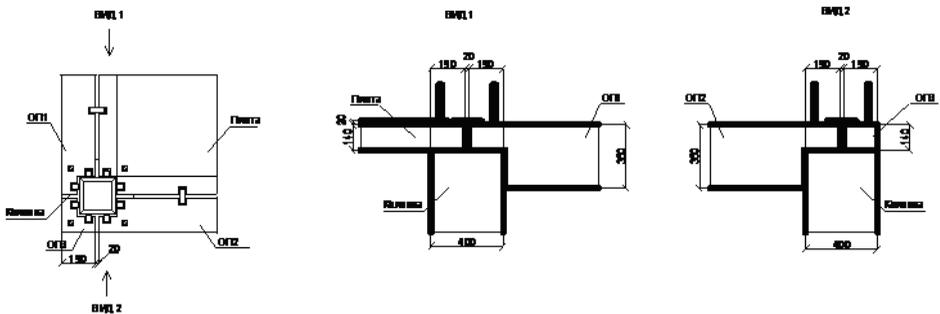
Узел сопряжения плит перекрытия с опорными вкладышами и колоннами
